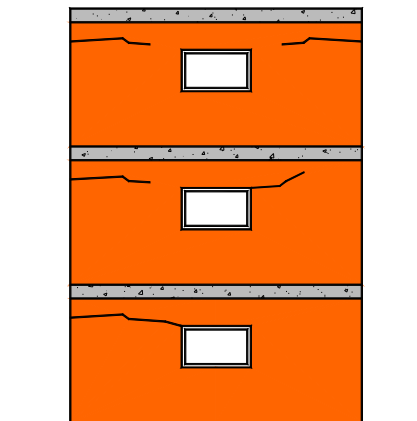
Fissuras em parede exterior, causadas pela retracção de lajes intermédias [30]
